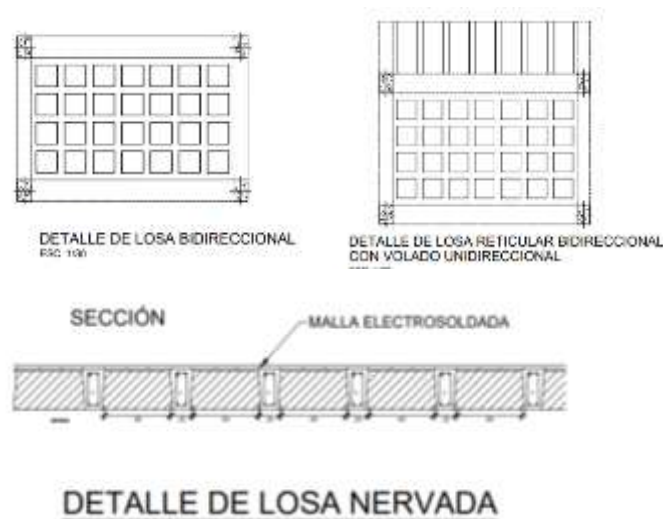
Detalle de Losa Reticular. *Fuente:* Autora (2023)
